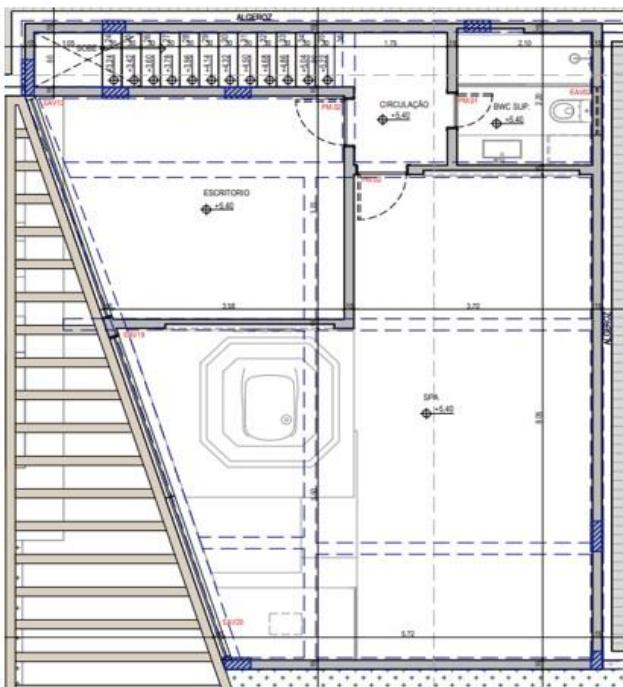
Planta arquitetônica do pavimento térreo e intermediário
